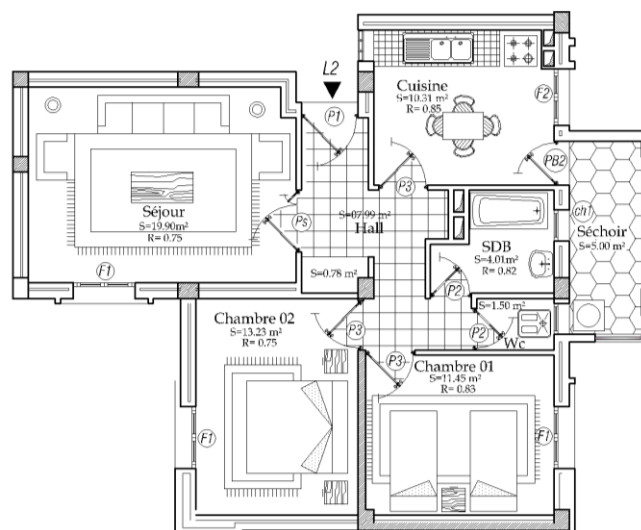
Vue en plan du logement étudié, (Source : Auteur)
